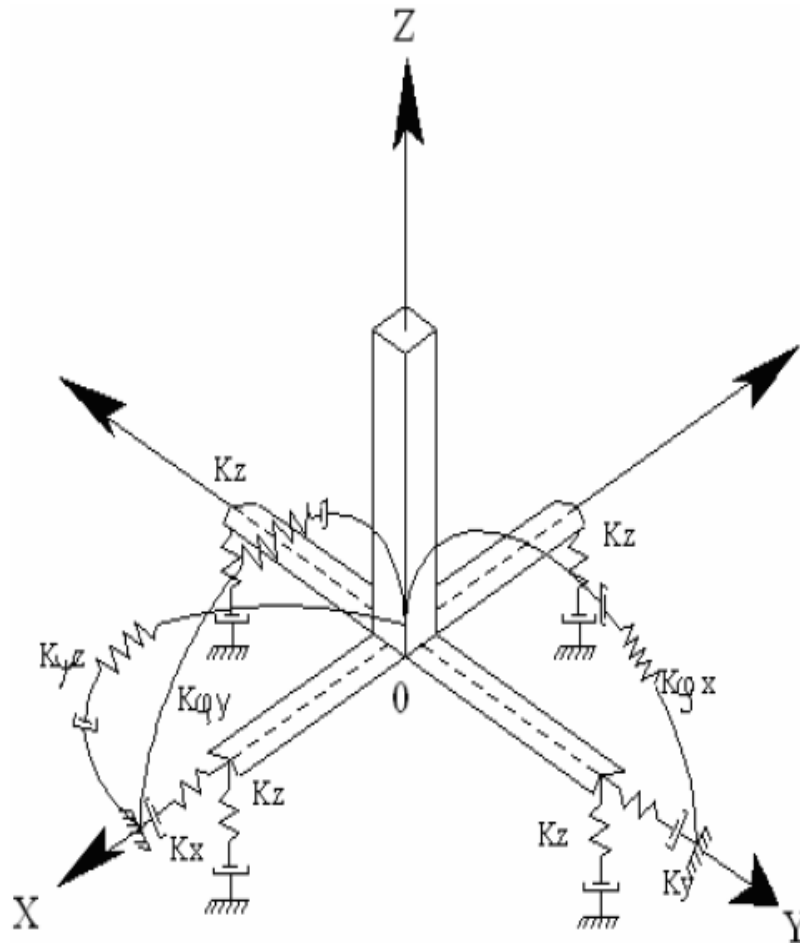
Imagen espacial de cálculo de la cimentación (cimentación zapata aislada)
